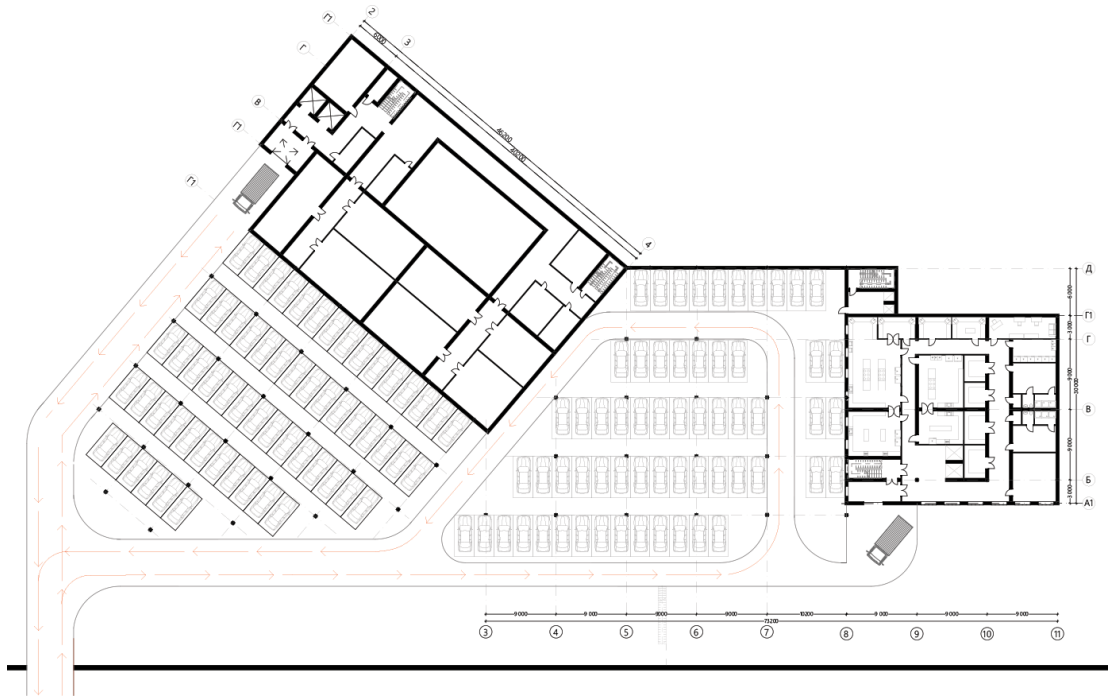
План цокольного поверху (на відм. -3,600)
